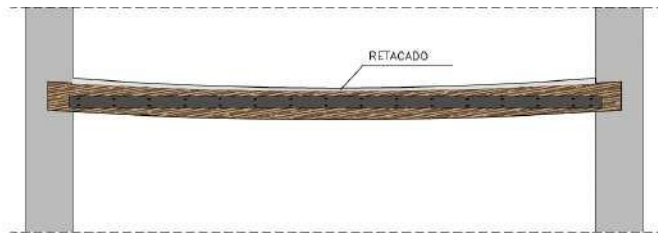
Refuerzo perfil metálico intermedio. Fuente propia
